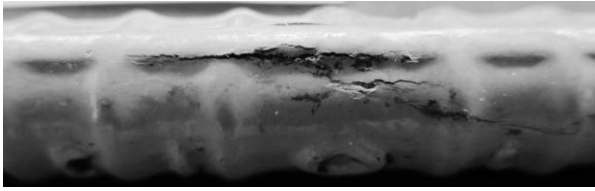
リブに沿った EP 樹脂塗装のひび割れ
